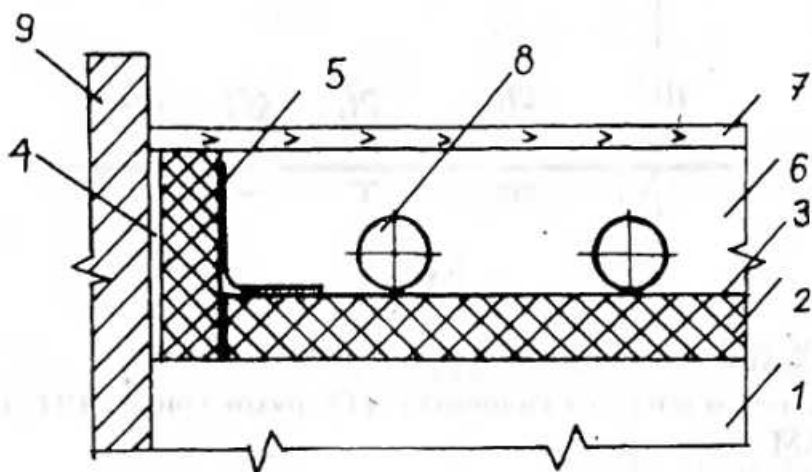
Конструкція підлогового нагрівача: 1 - основа перекриття; 2 - тепла ізоляція; 3 - пароізоляція; 4 - м'яка берегова плита; 5 - еластична плівкова пароізоляція; 6 - бетонна плита; 7 - підлога; 8 - пластмасовий трубопровід
